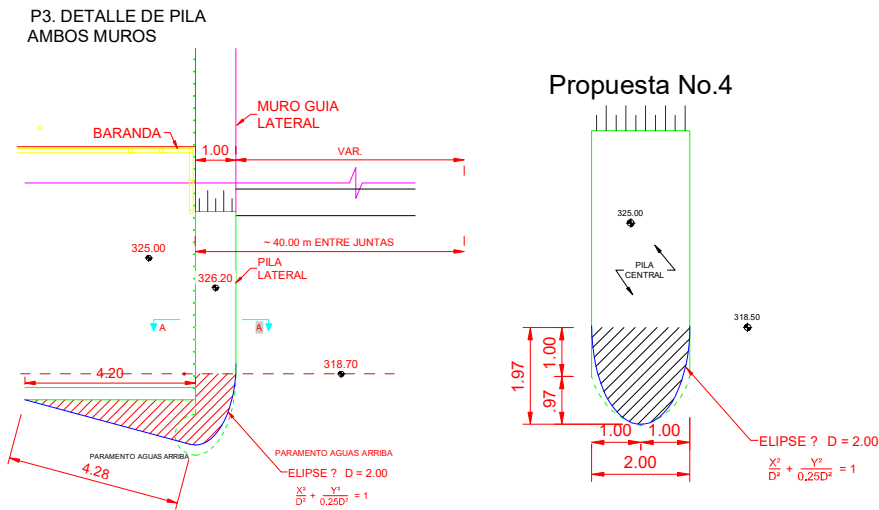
Vista en planta de la geometría de modificación de pilas laterales y centrales propuestas para la serie 6.
